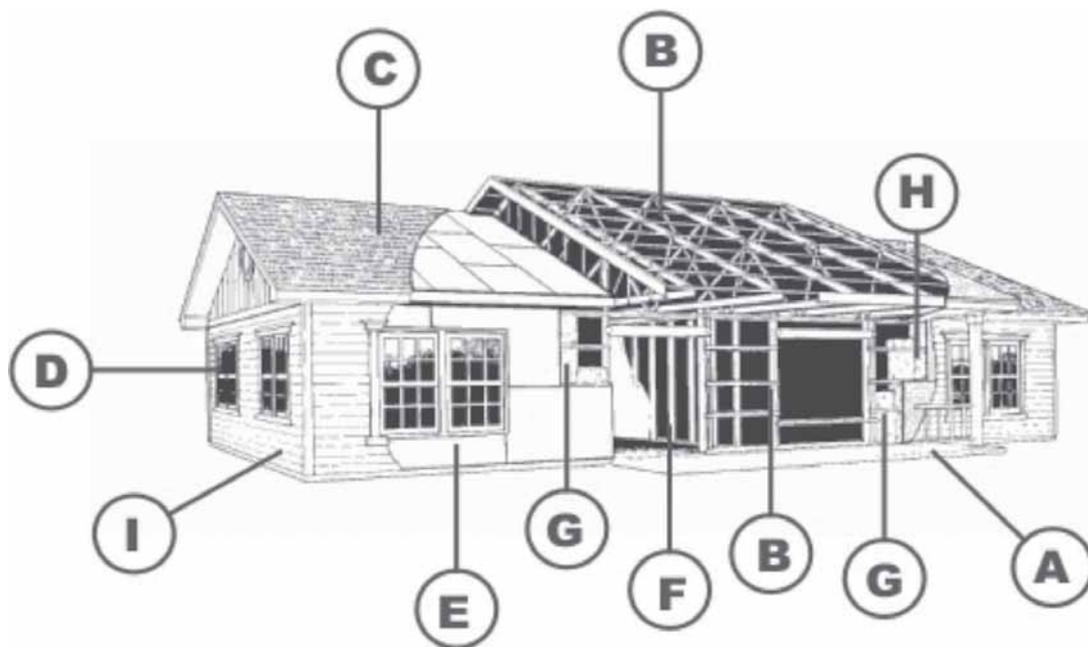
Etapas de montagem do sistema a seco em light steel framing
